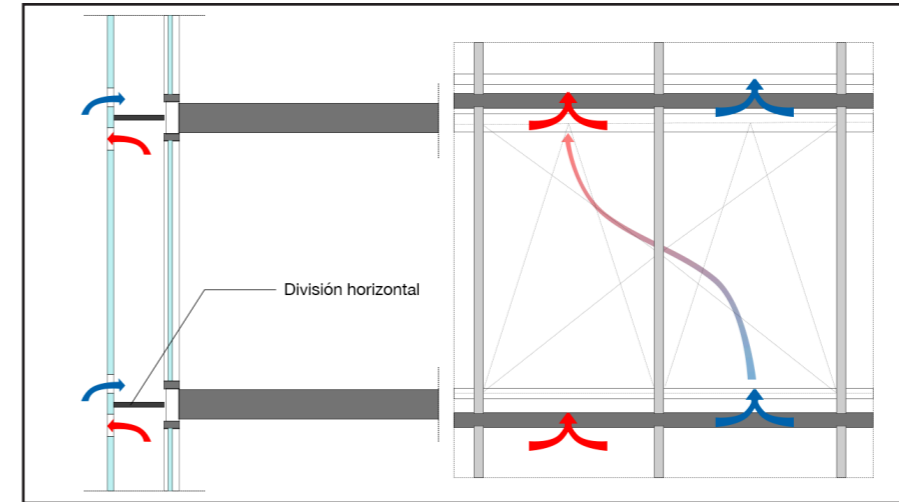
| Esquema de una Fachada Corredor, izquierda: sección, derecha: alzado.
